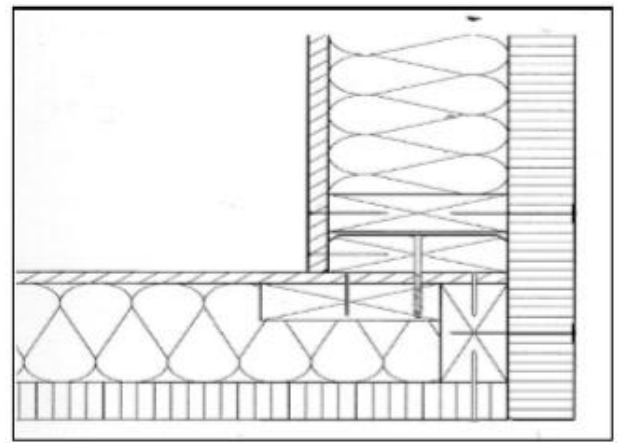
coupe transversale du détail d'assemblage deux murs extérieurs
